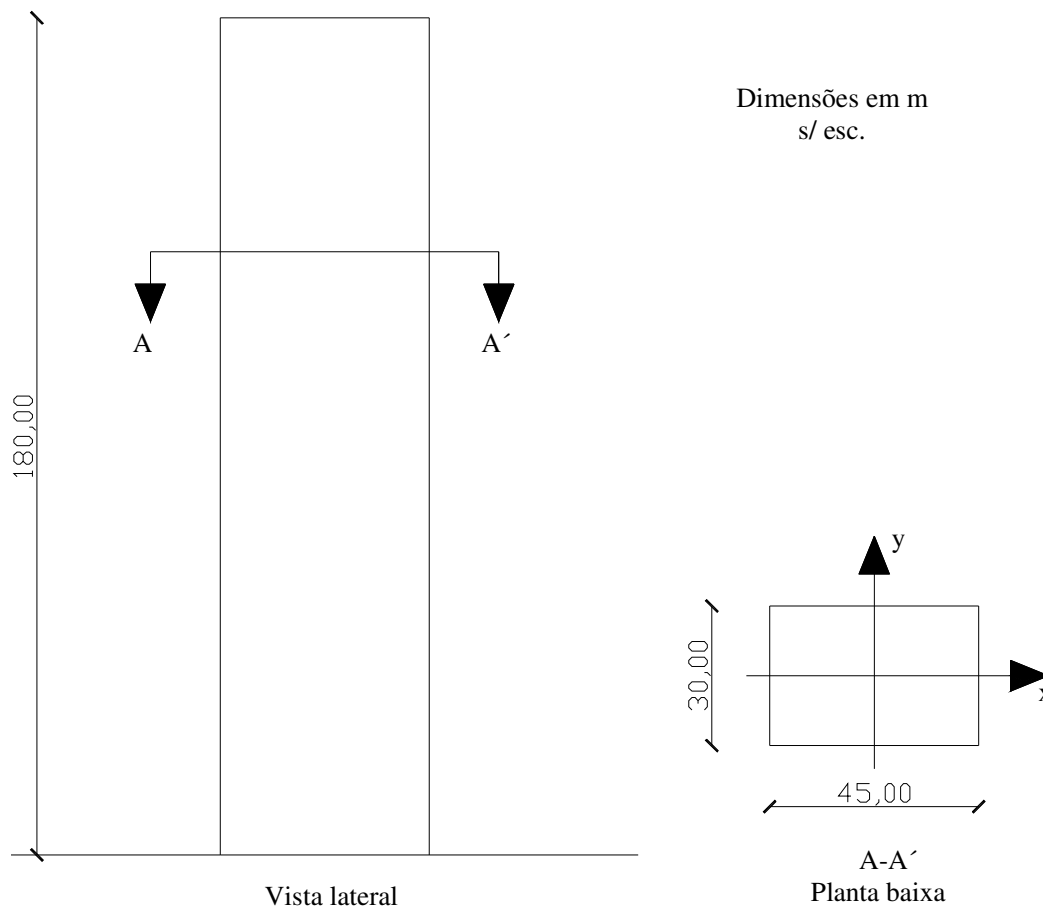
Planta baixa e vista lateral do “CAARC Standard Tall Building”.
